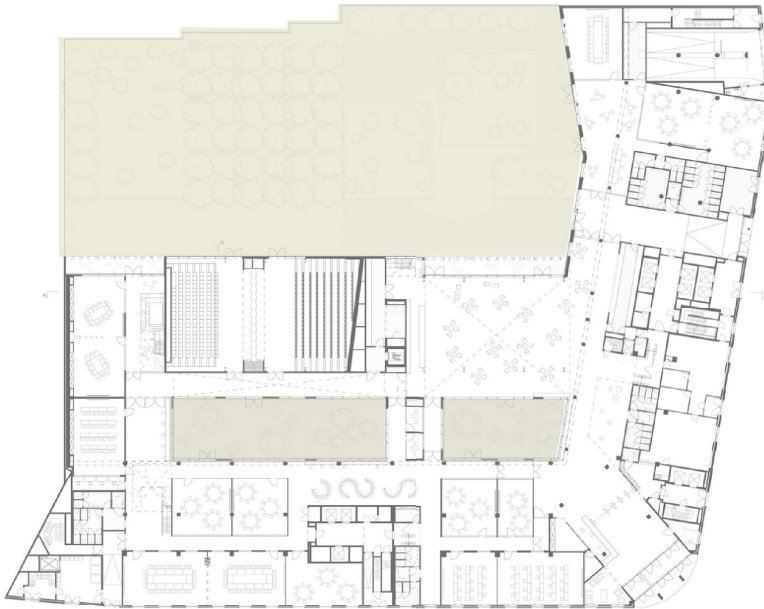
Diagrama de espacios exteriores sobre plano de la planta baja .
